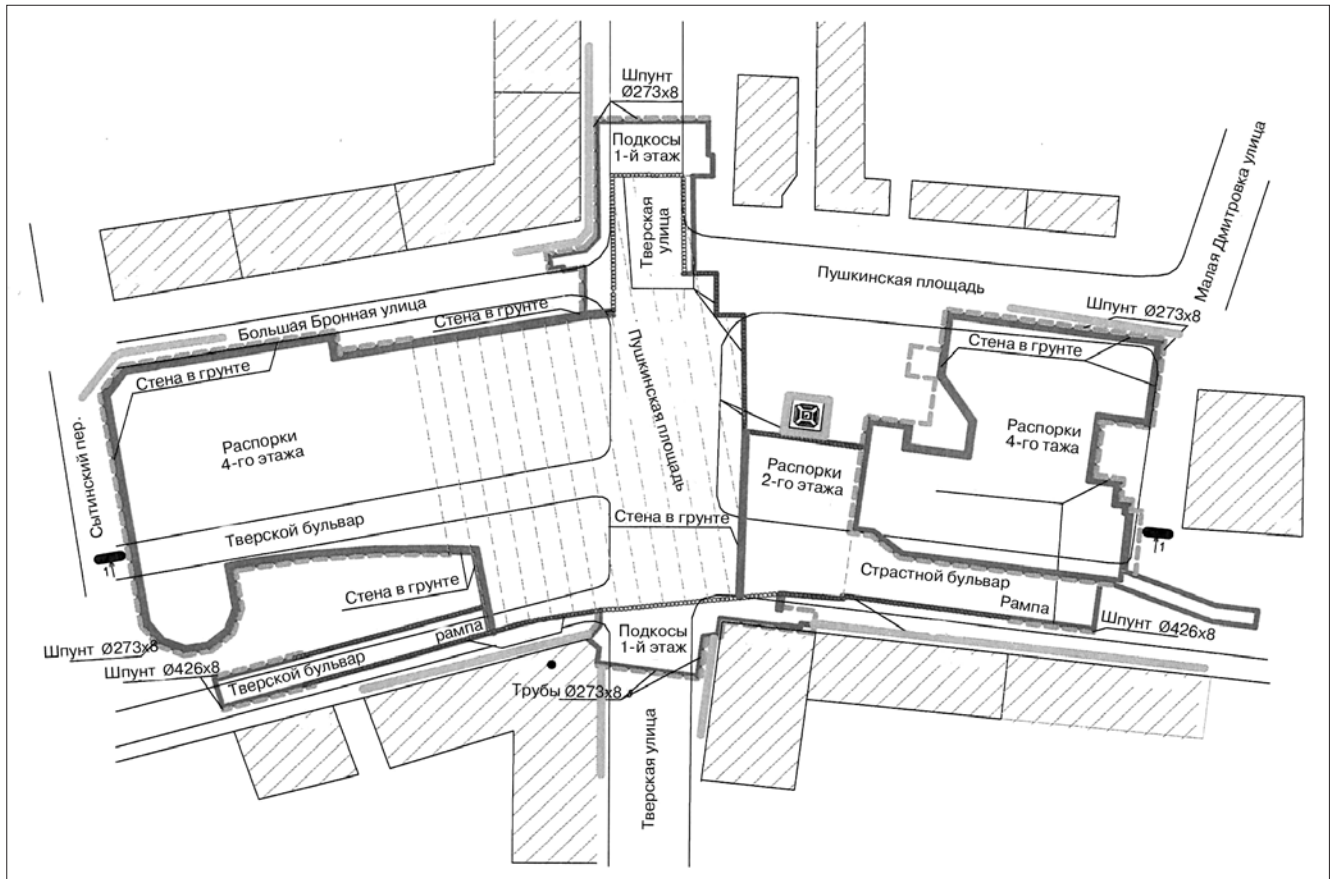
Схема расположения конструкций транспортного узла на Пушкинской площади
